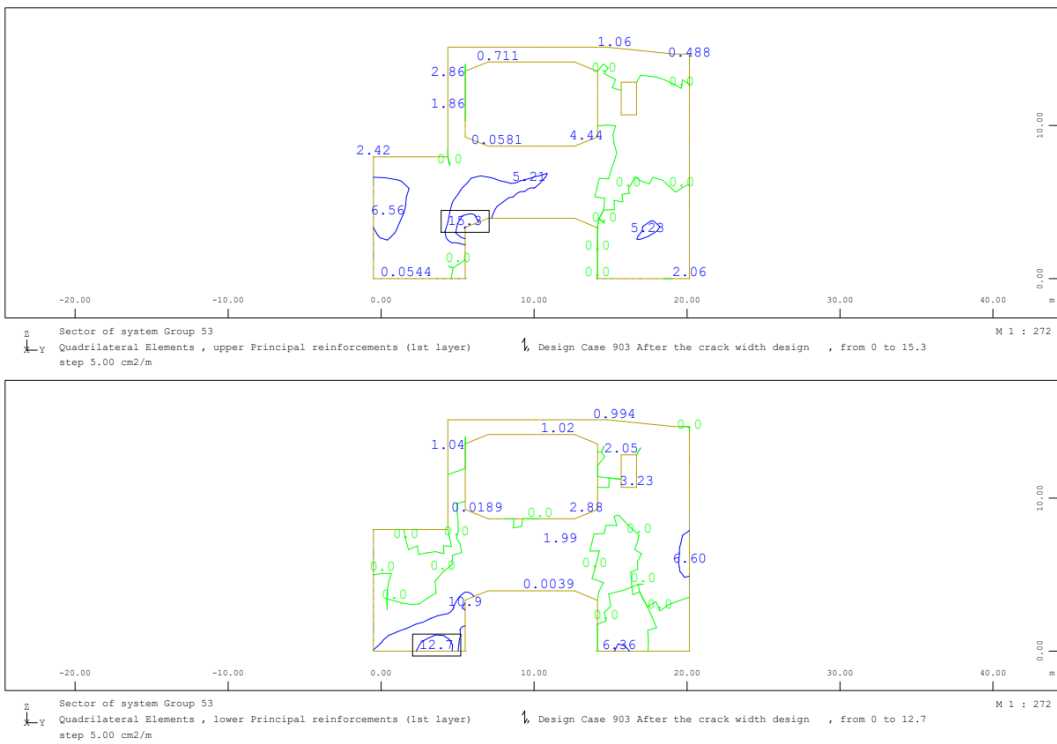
Armadura vertical na face exterior (sup.) e interior (inf.) – fachada Oeste da Estação - ELS
